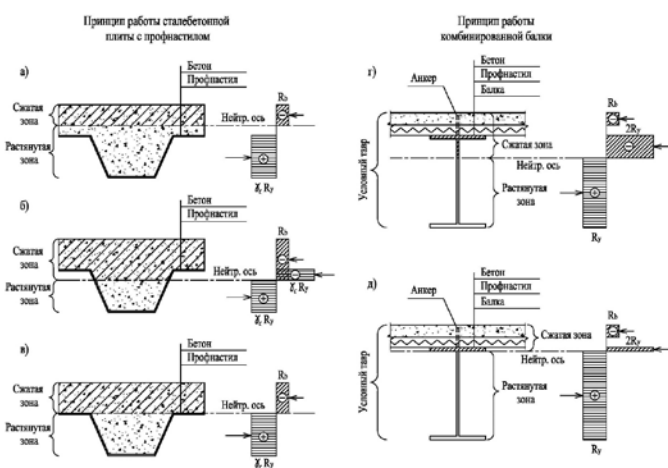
Принцип работы сталебетонного перекрытия: а) – нейтральная ось располагается в полке плиты и не пересекает стенок профнастила; б) – нейтральная ось пересекает стенки профнастила; в) – нейтральная ось расположена на уровне верхней полки профнастила г) – нейтральная ось пересекает стенку комбинированной балки; д) – нейтральная ось расположена в верхней полке комбинированной балки
